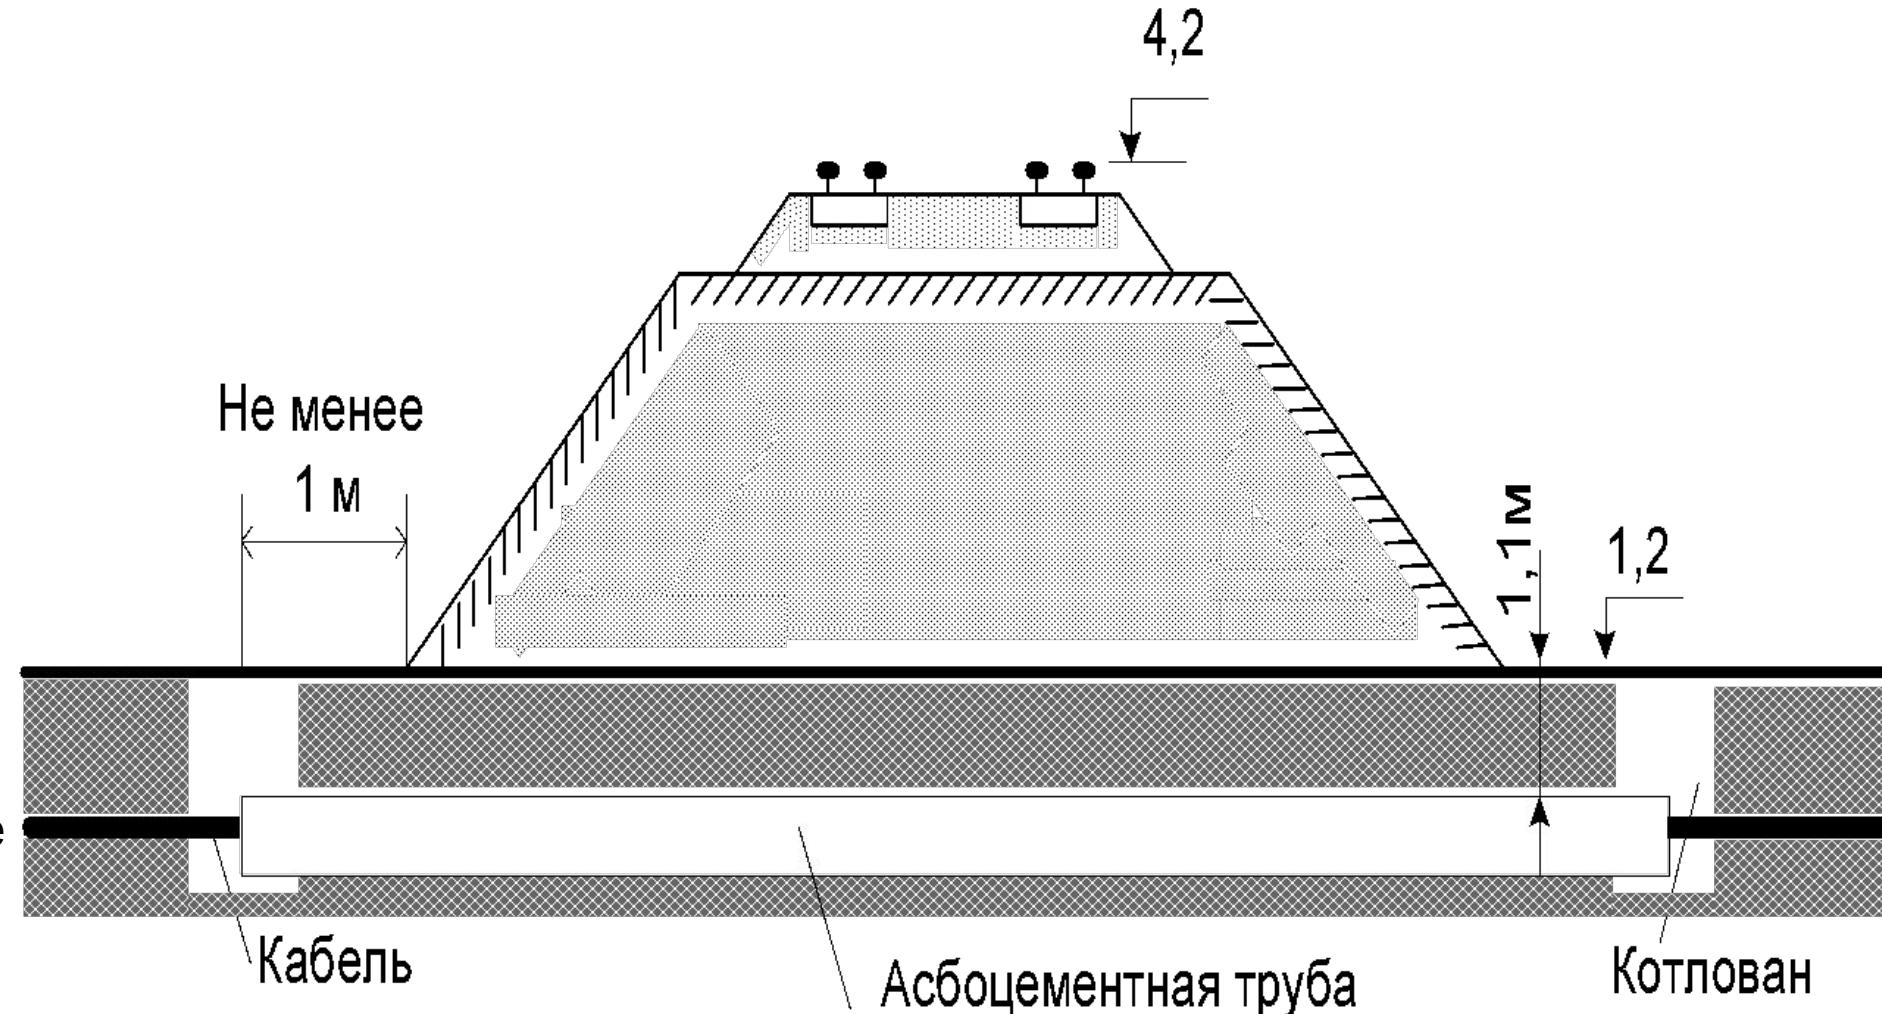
Прокладка кабеля под железнодорожной насыпью
